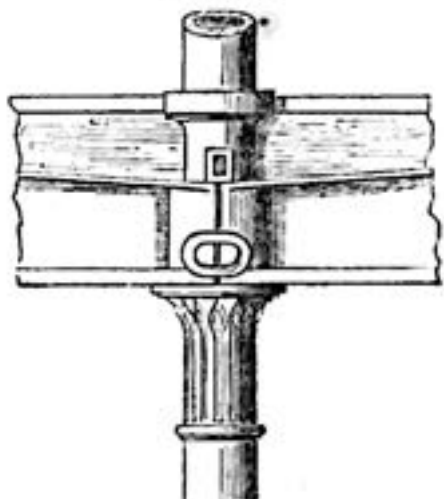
| Sistema costruttivo misto con pilastro in ghisa a sezione cava e trave in ferro con giunti bullonati; impalcato ligneo per ripartizione dei carichi, in *Cast and Wrought Iron to Building Purposes*, Longman, Green, Roberts, 1864.
